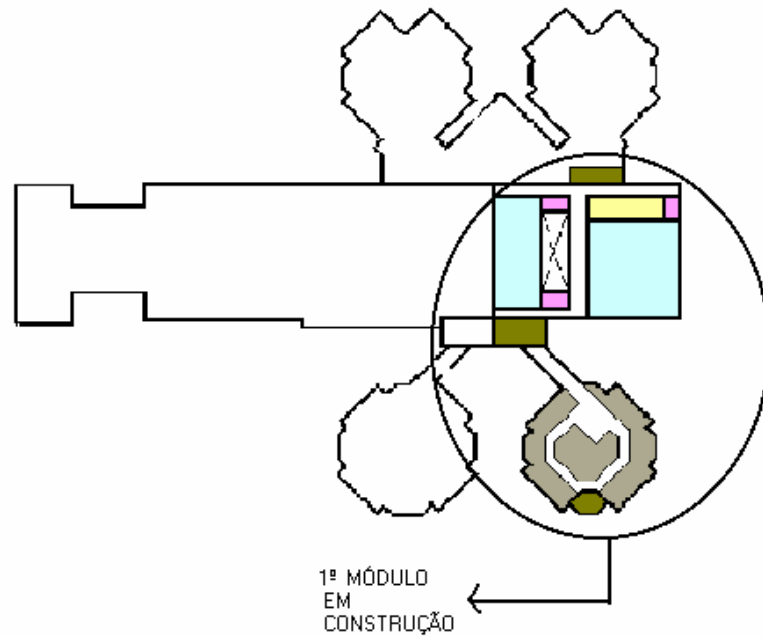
Planta de Situação (Croqui) do Centro de Atenção à Saúde / UFJF
